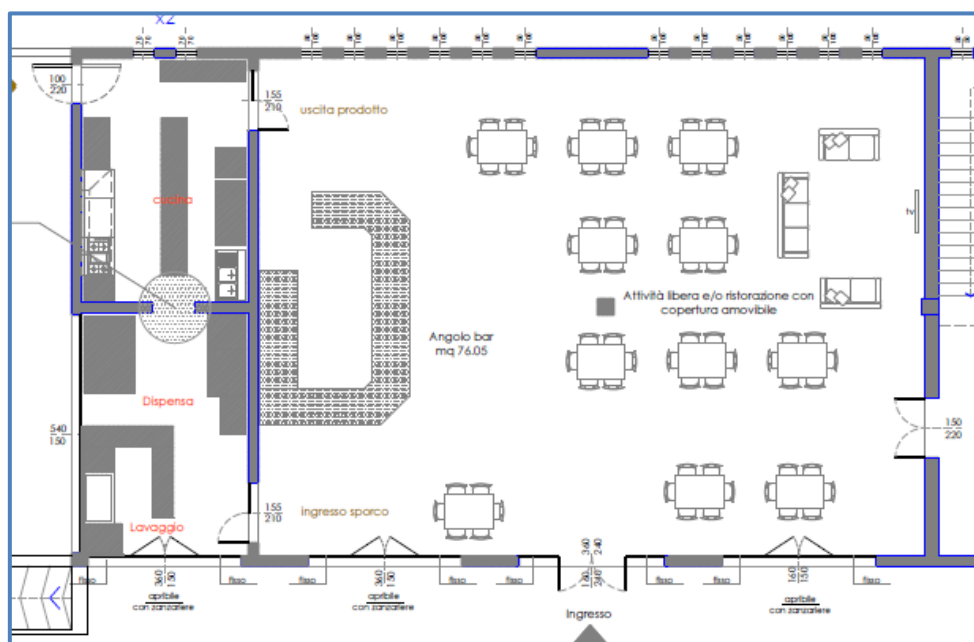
porzione di fabbricato al piano terra con cucina e bar-ristorante
